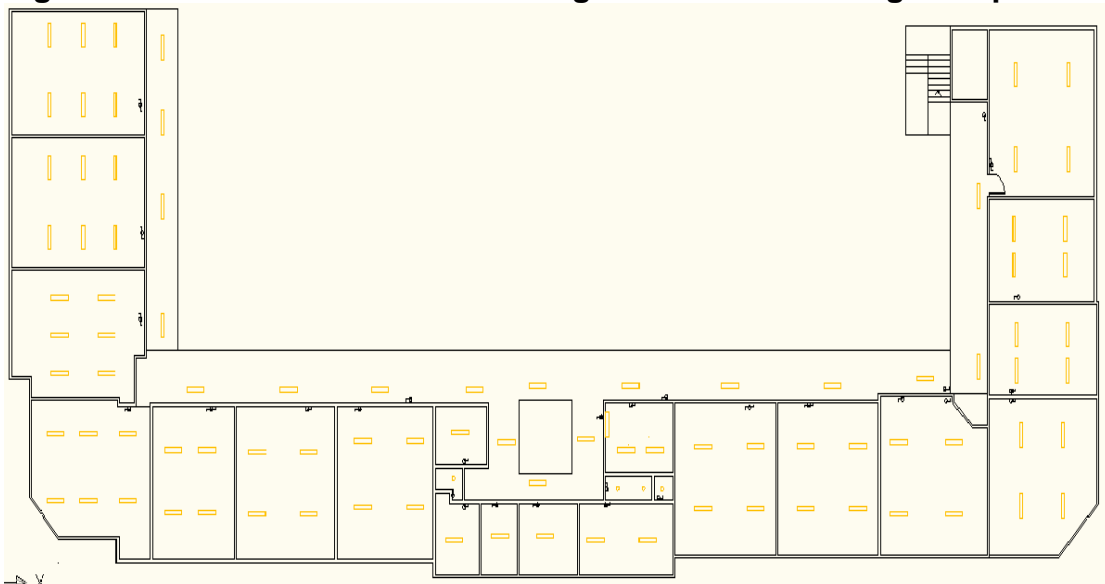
Plano estructuras del colegio la inmaculada segundo piso.
